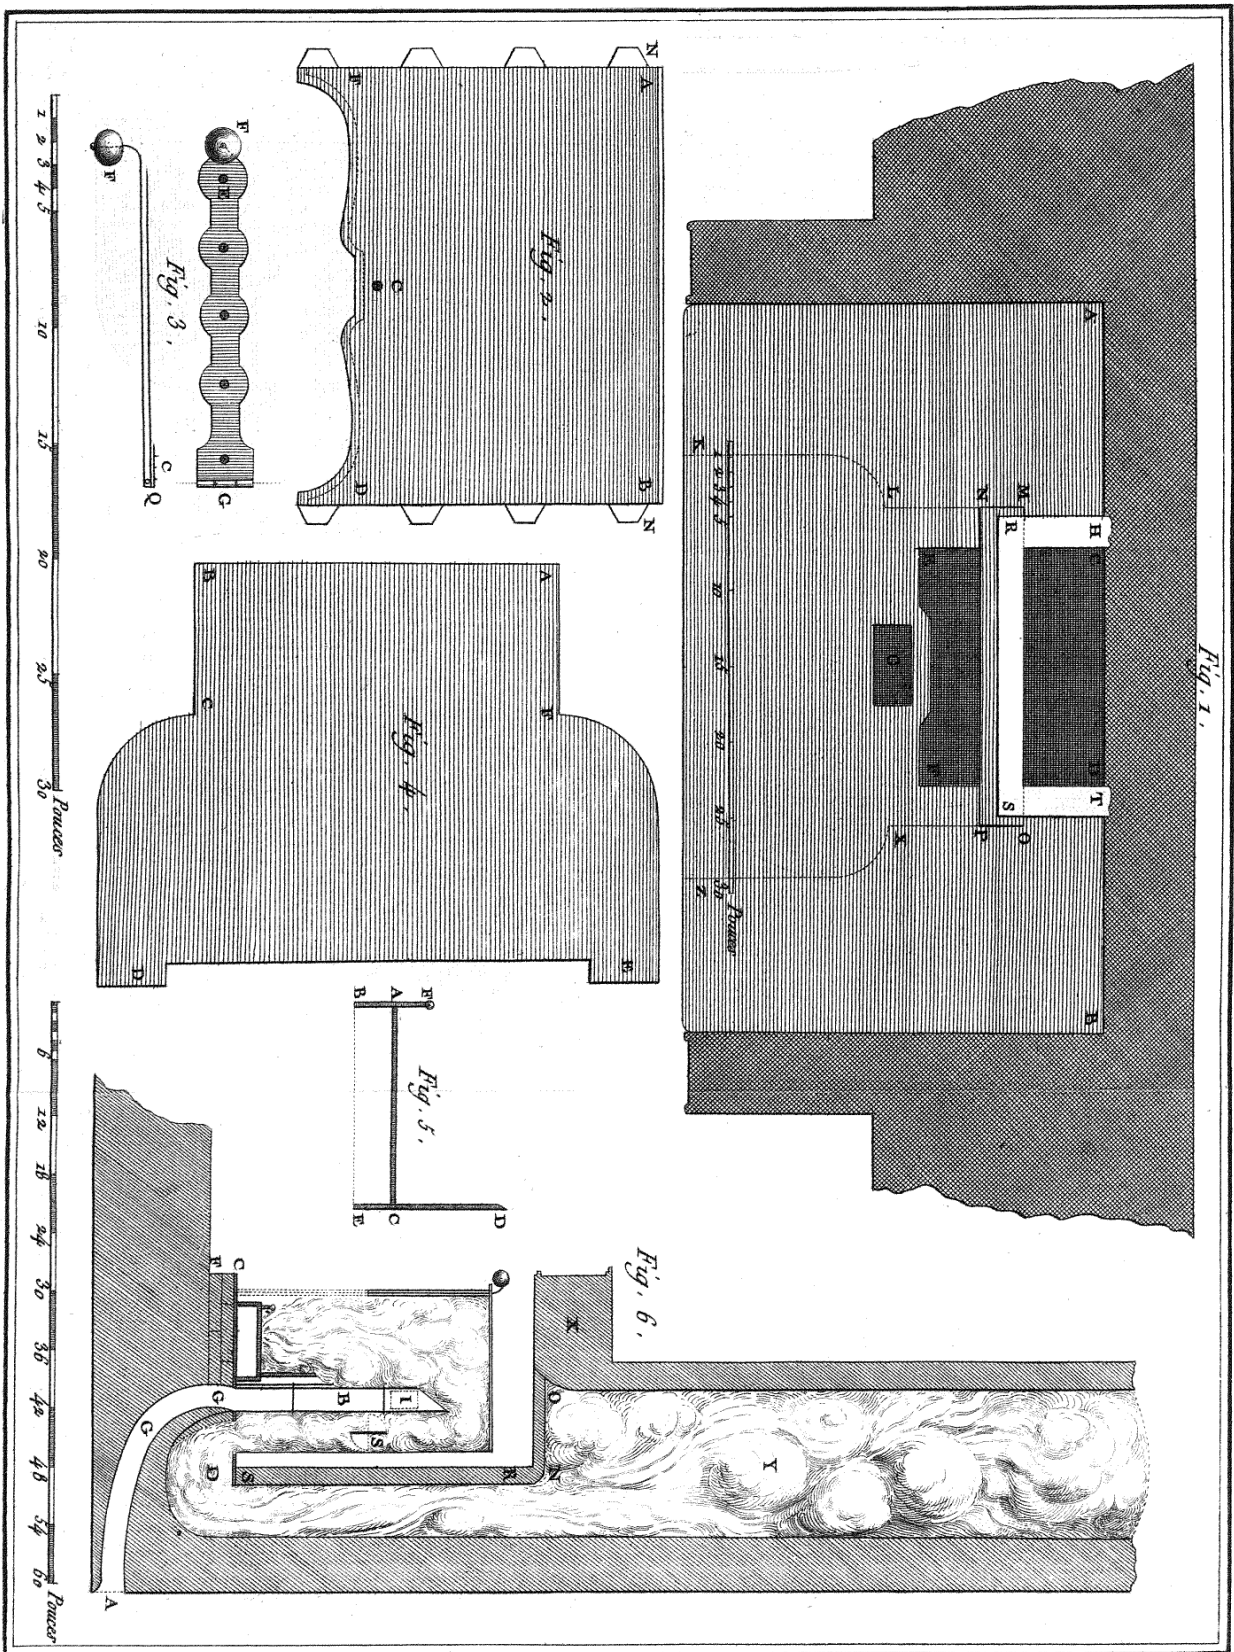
Profil d'une Cheminée posée contre un mur, entre deux pilastres : l'espace entre les pilastres est occupé par une glace posée sur une tablette qui couvre, à six pouces de haut, la queue de la Cheminée.
